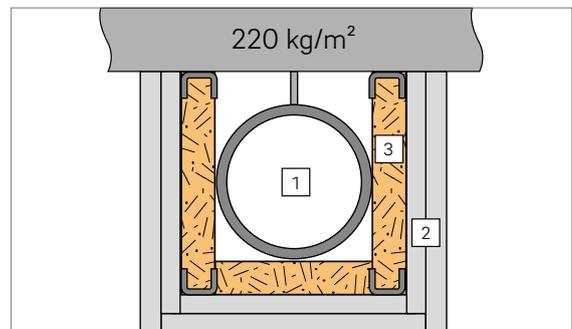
Esempio di esecuzione 2 - Posa in controsoffitto - Rivestimento delle tubazioni con isolamento
